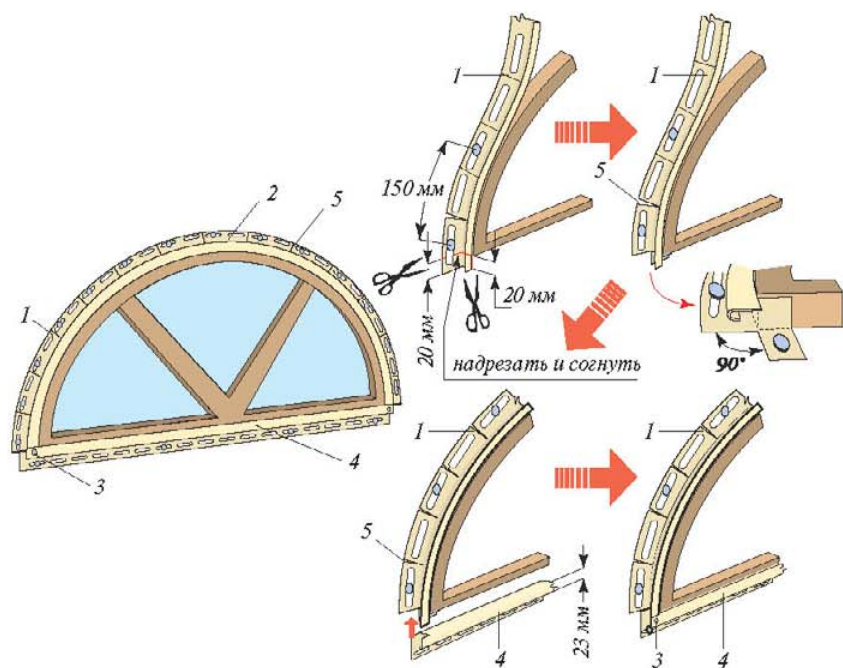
Установка обрамлений вокруг арочных и круглых окон: 1 — гибкий J-профиль; 2 — крепеж; 3 — заклепки; 4 — нижняя обвязка, обычный J-профиль
